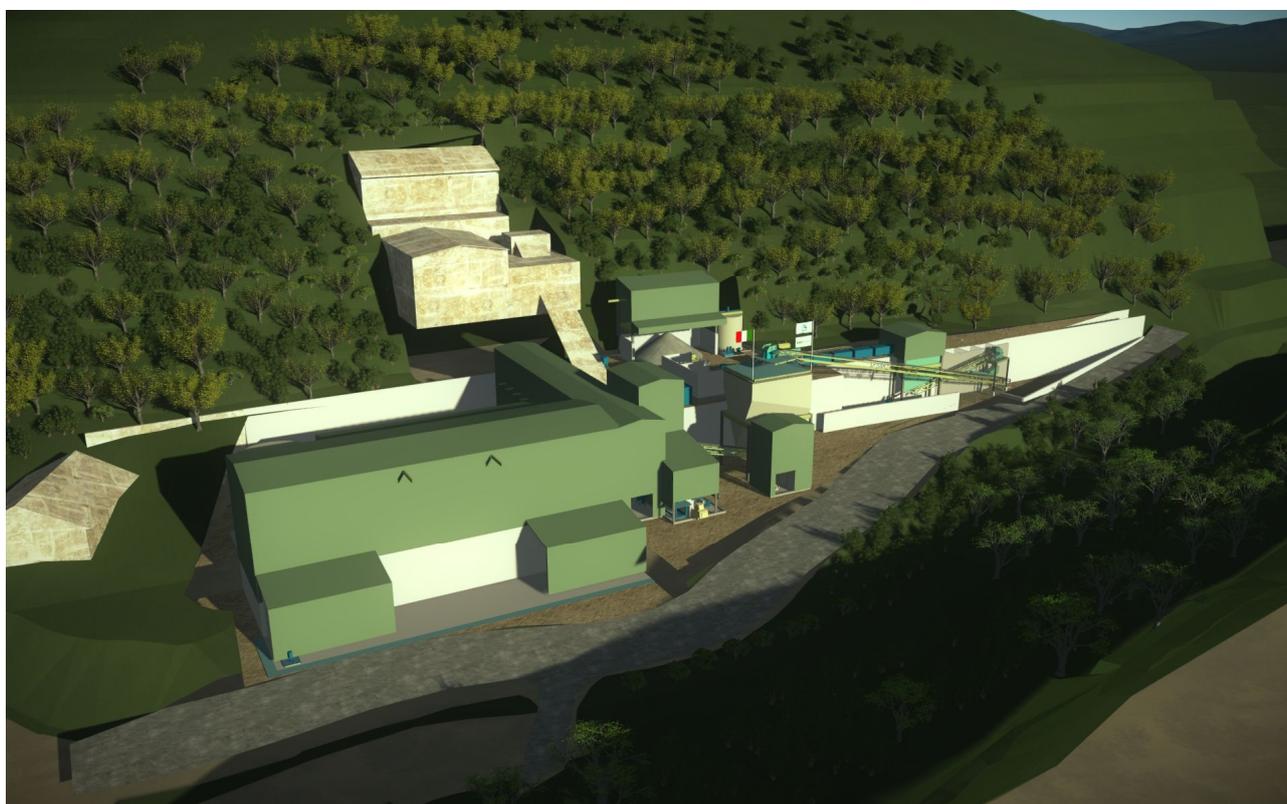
Rendering dell’impianto di trattamento e lavorazione in loc. Riso.
